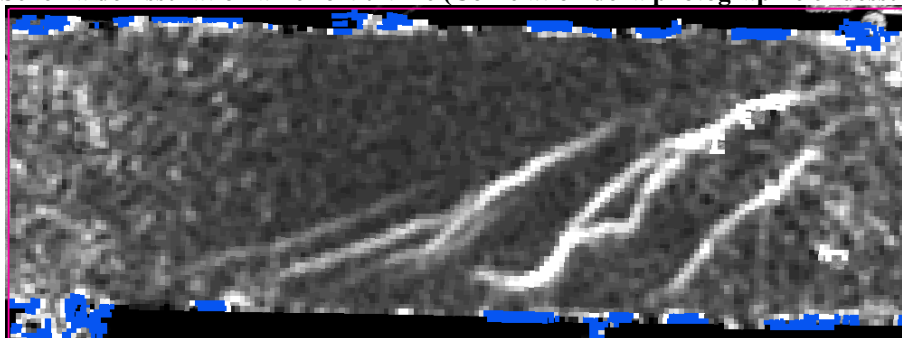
Position des extensomètres par corrélation d'images sur la poutre « R40-C-U-Is-TRC(2) »
